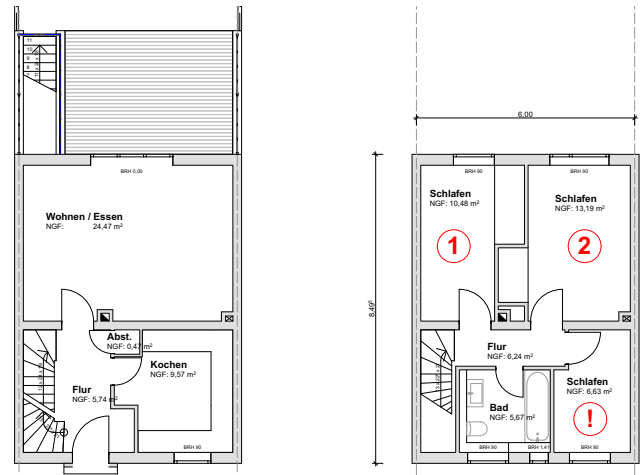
Grundriss Bestand Typ C3 RH
